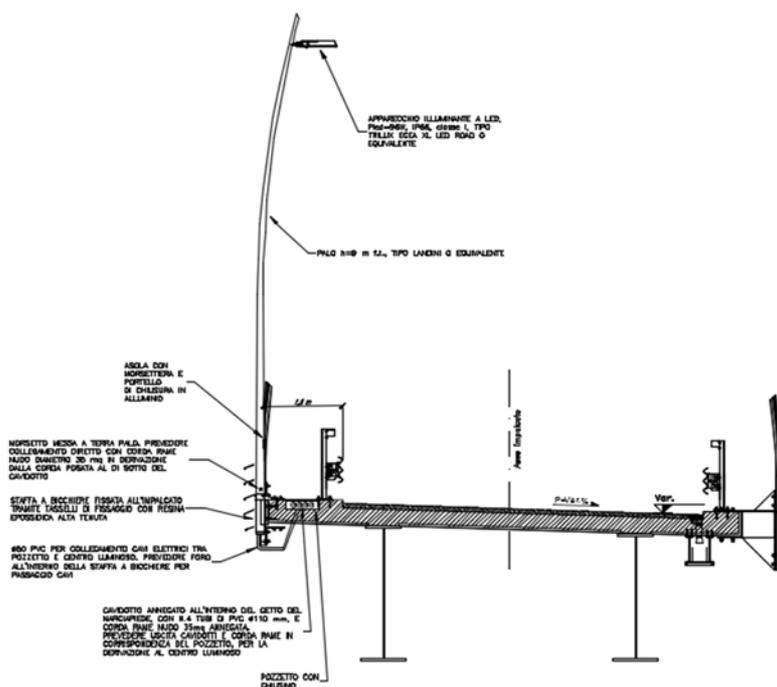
Particolare di installazione cavidotto e palo su impalcato stradale
